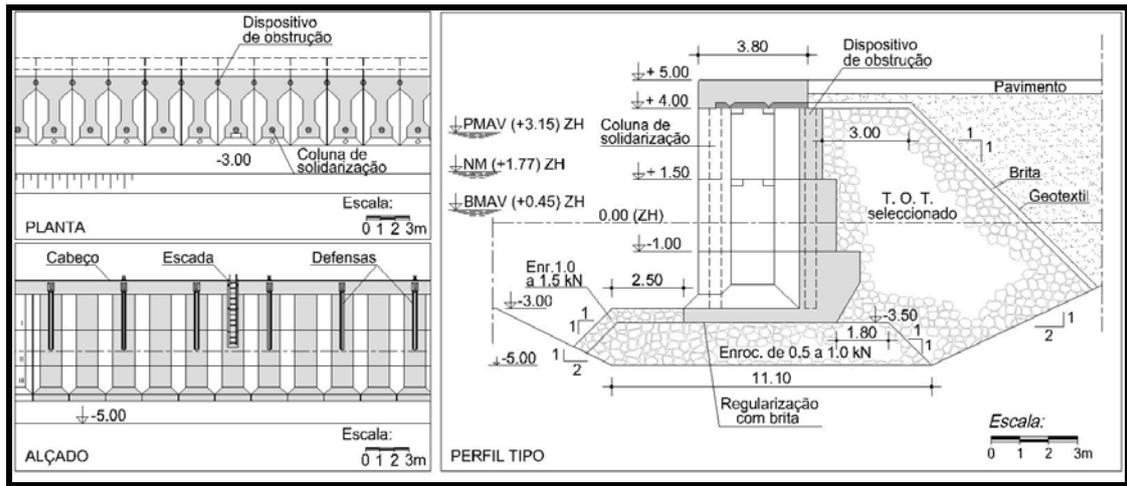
Planta, alçado e corte do muro-cais do porto da Afurada
